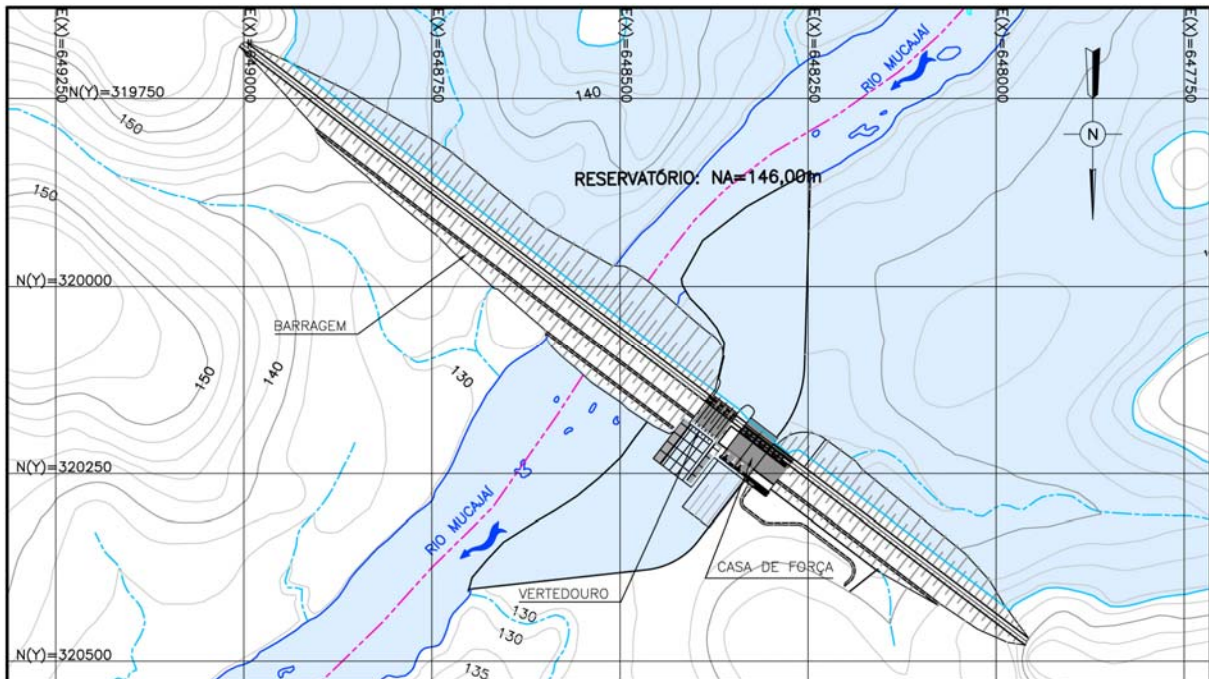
Arranjo Geral do AHE Paredão M1 - Planta
